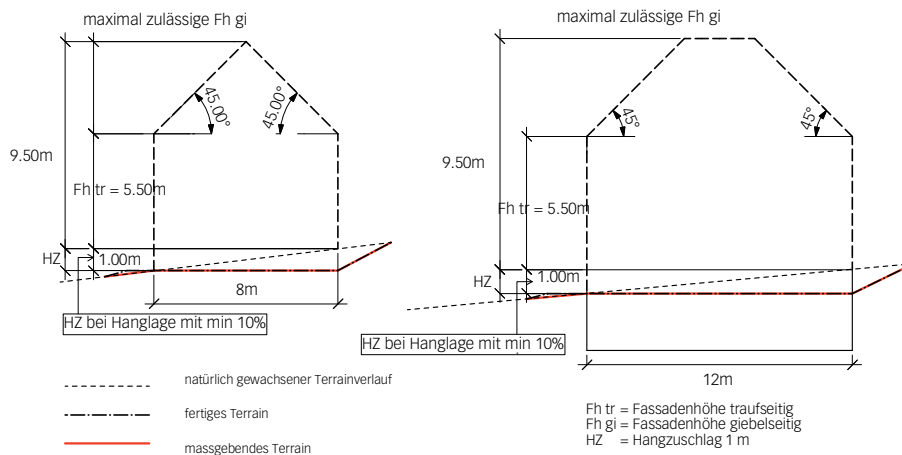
Zulässige Dachgestaltung innerhalb der zulässigen Fh tr und Fh gi
